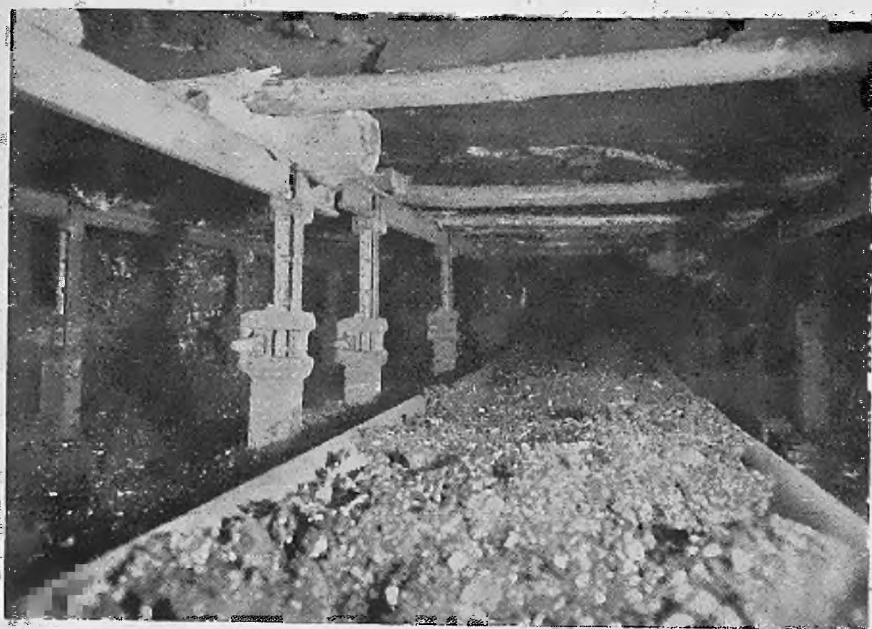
Strebausbau mit Gerlach-Stahlstempeln
